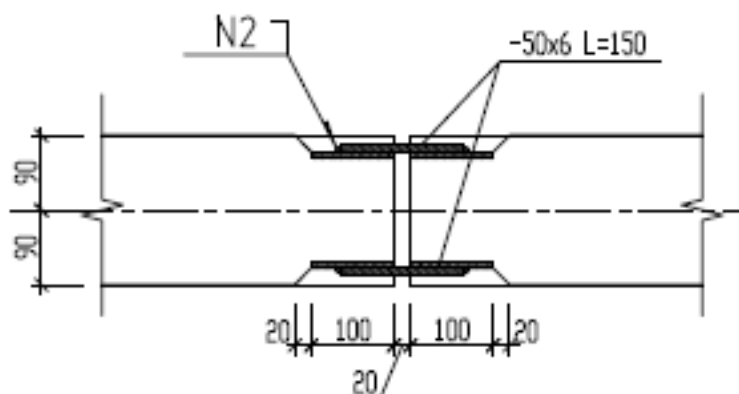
Конструкция расположения стыковых пластин на боковых торцах при устройстве вертикального упругоподатливого стыка наружных стеновых панелей (вид сверху): N2 – закладная деталь; 50x6 – размеры привариваемых пластин (обеспечивающие соединение); L=150 – длина пластин.
